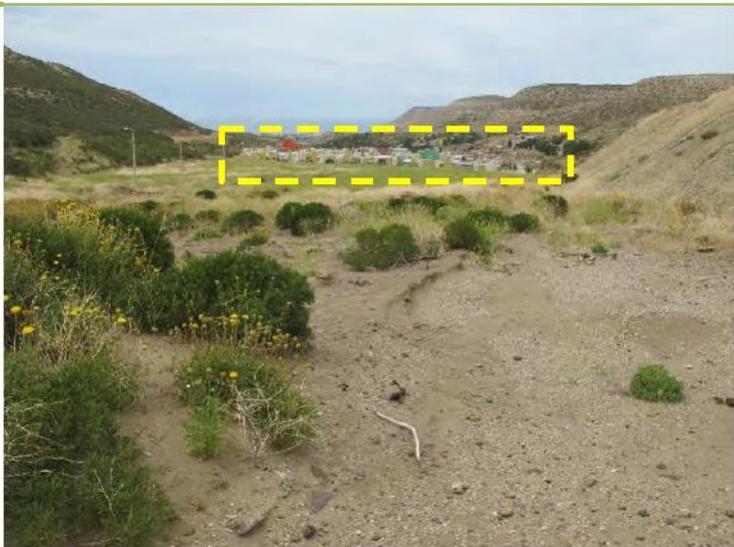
Zona donde se proyecta construir el Reservorio R01 ubicado al suroeste de la cuenca, sobre el camino Roque González. Se observa el Barrio Nuevo ubicado aguas abajo. Vista en dirección Sureste.
